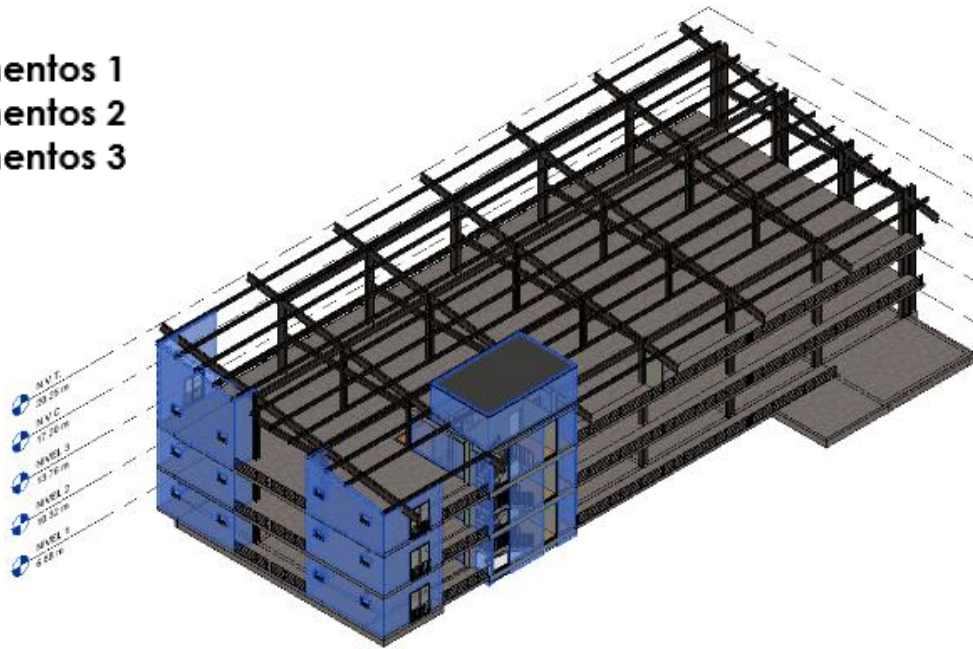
Muros de hormigón armado en el sector oeste y en el módulo de circulación vertical a conservar en la nueva propuesta. Fuente: Elaboración propia
